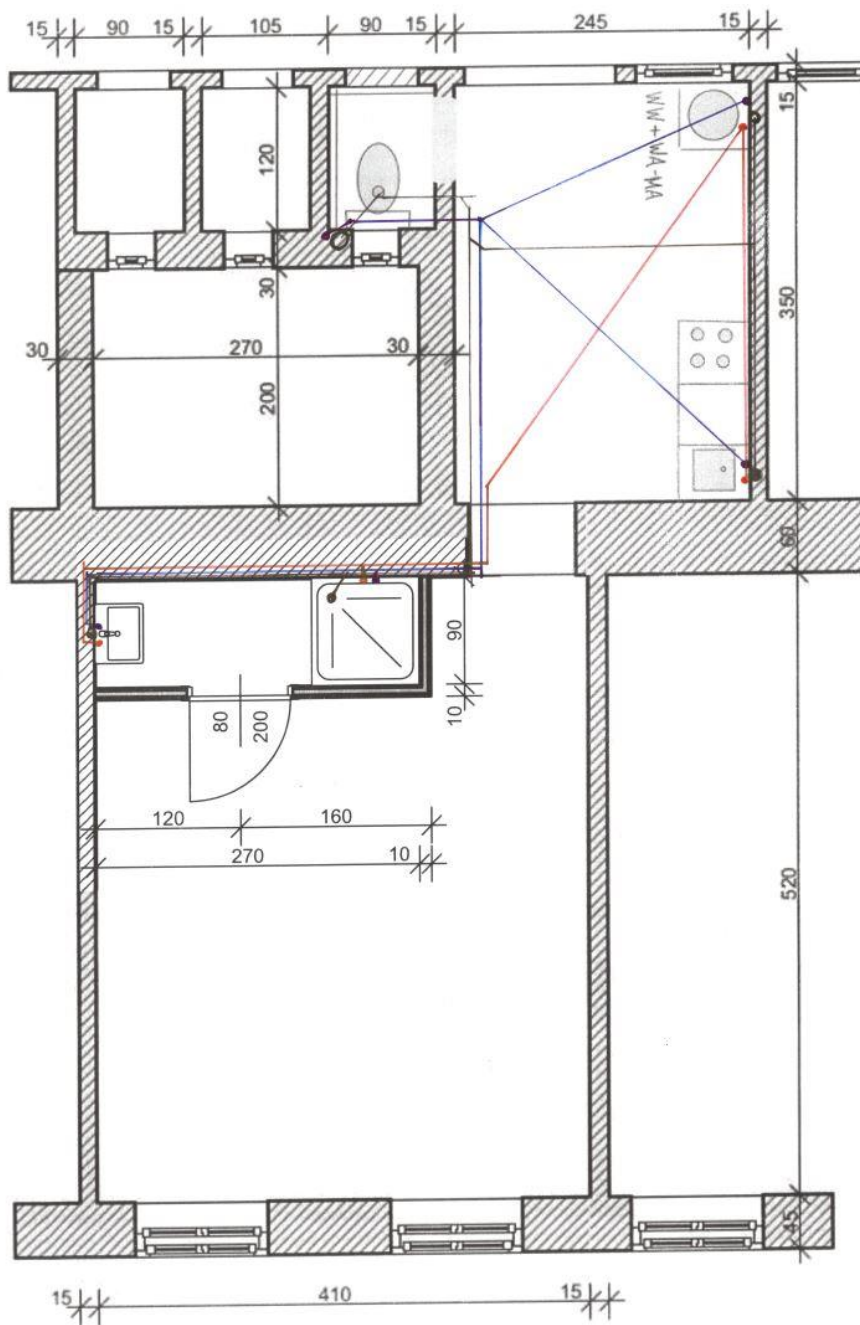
Grundriss mit Wasser- und Abwasserplan
